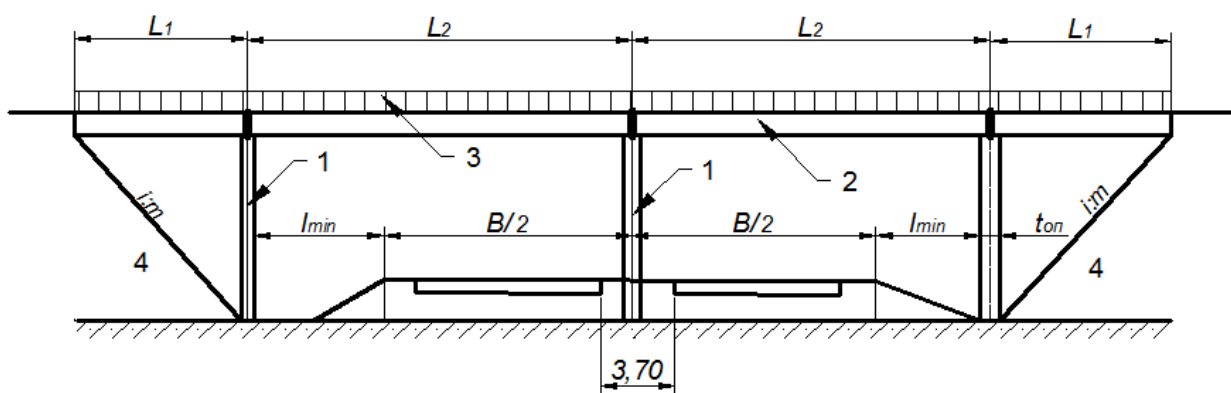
Схема четырехпролетного балочного путепровода: 1 – опора; 2 – пролетное строение; 3 – перила; 4 – конус насыпи
